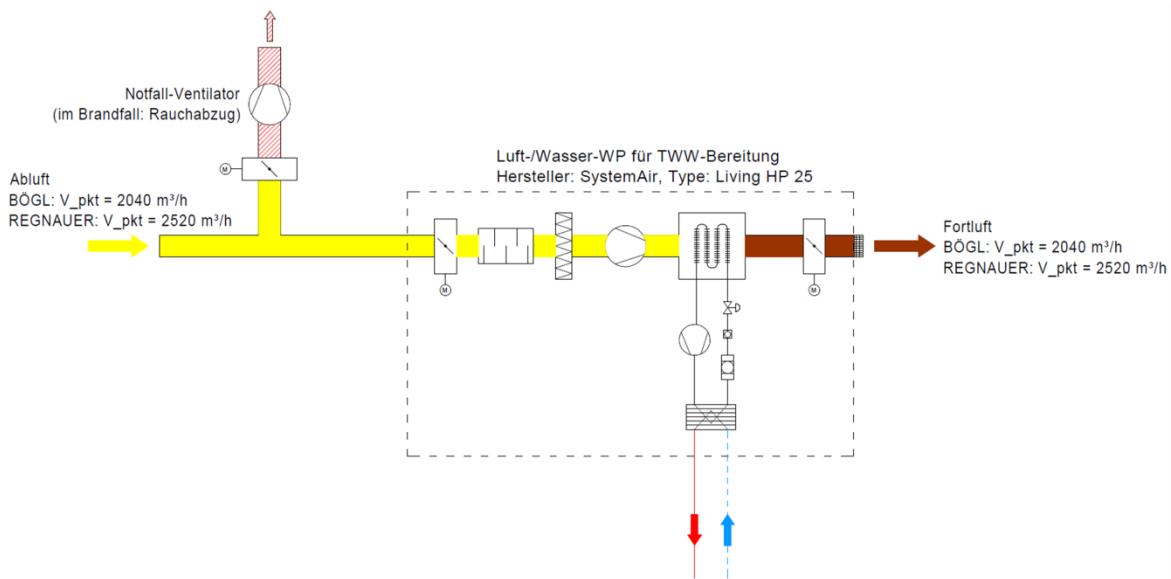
Ausschnitt Schemazeichnung Wärmepumpe zur TWW-Bereitstellung (gesamtes Schema in Anhang D)
